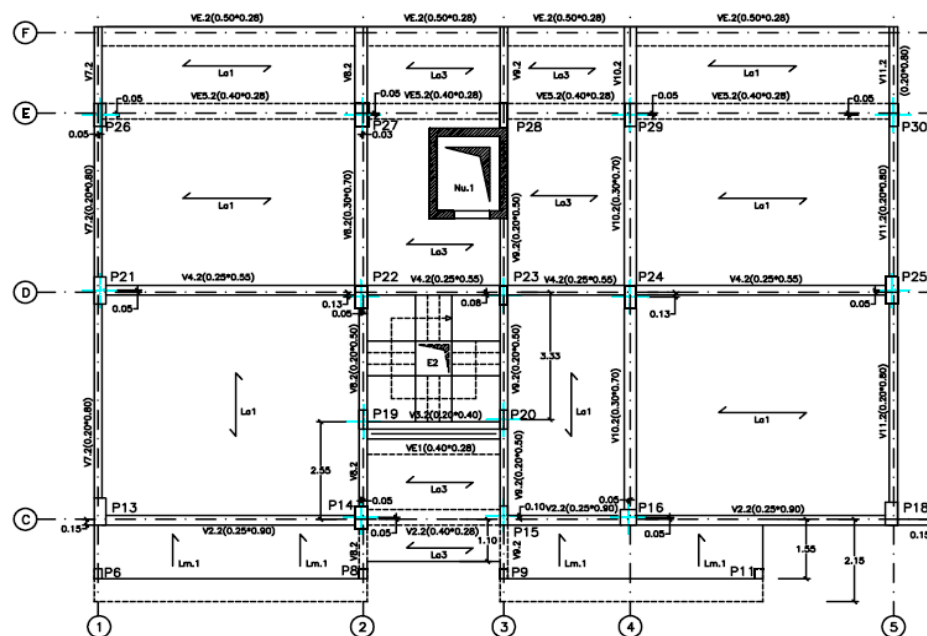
Planta estrutural do piso tipo do edifício de Avanca.
